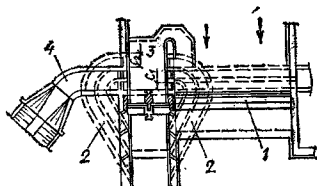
Двусторонний боковой водозаборный гидроузел с наносоперехватывающими галереями
